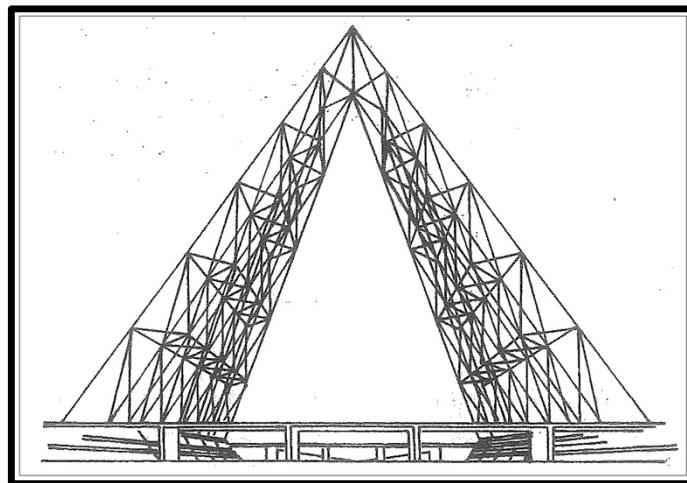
Vehicle Assembly Building Planı (Schueller, 1977)
